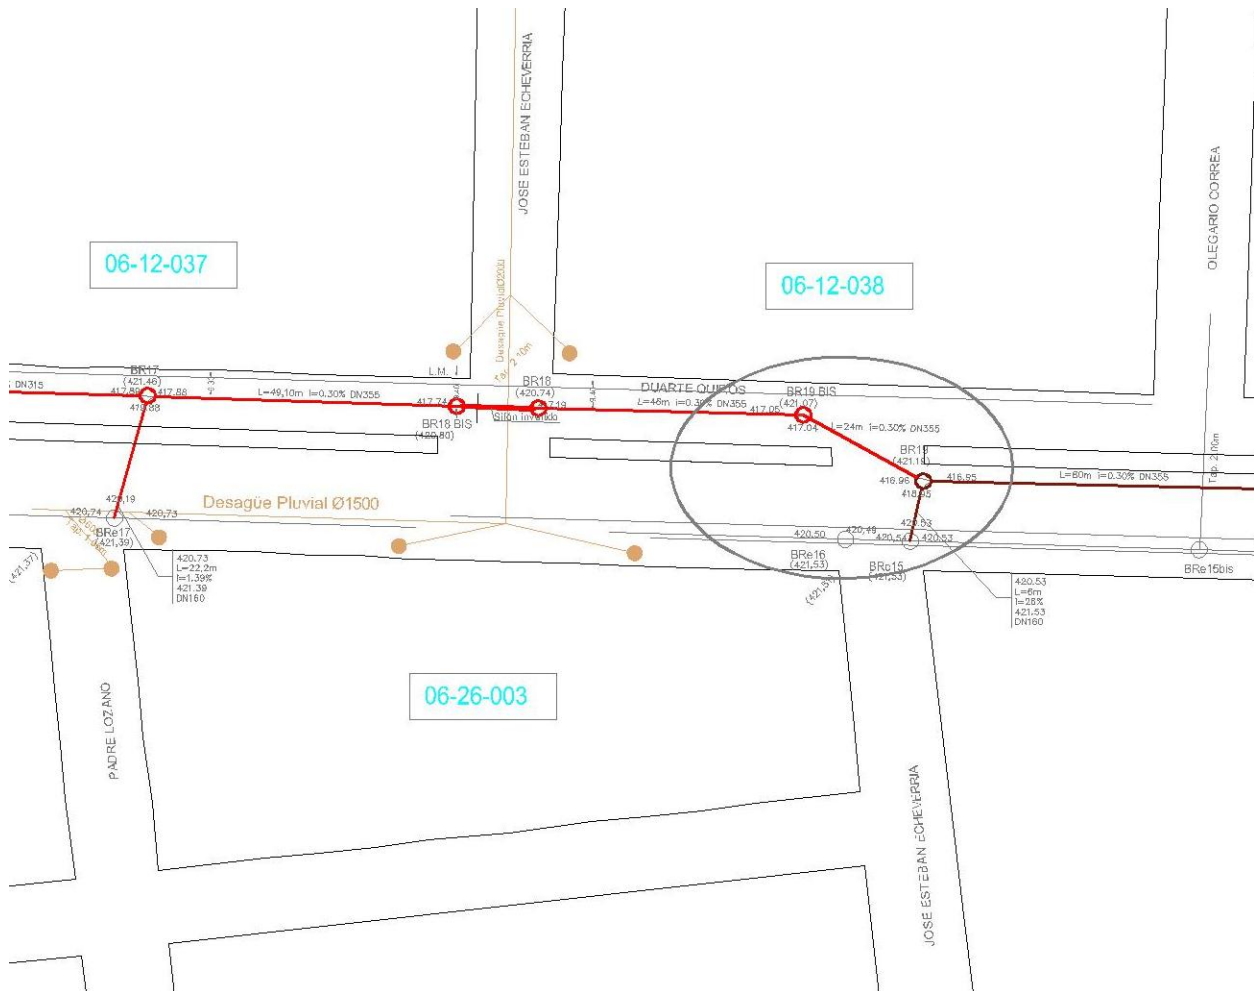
Cruce de calzada para tendido de red colectora en calle Duarte Quirós.
